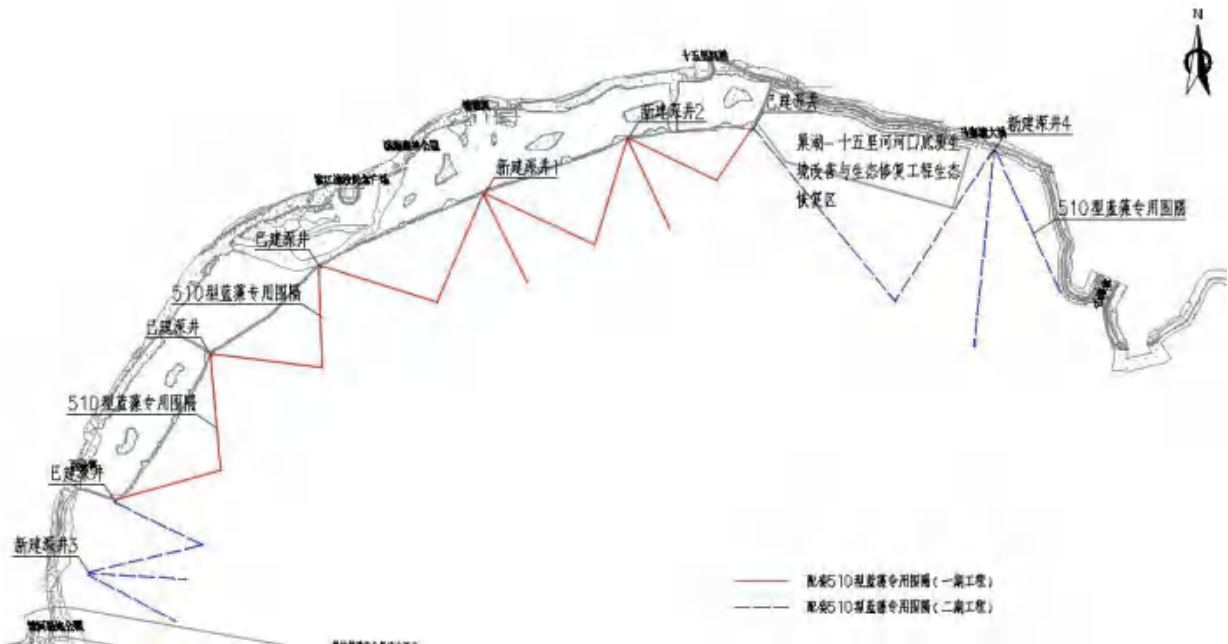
包河区巢湖蓝藻离岸防控应急项目总平面布置图
